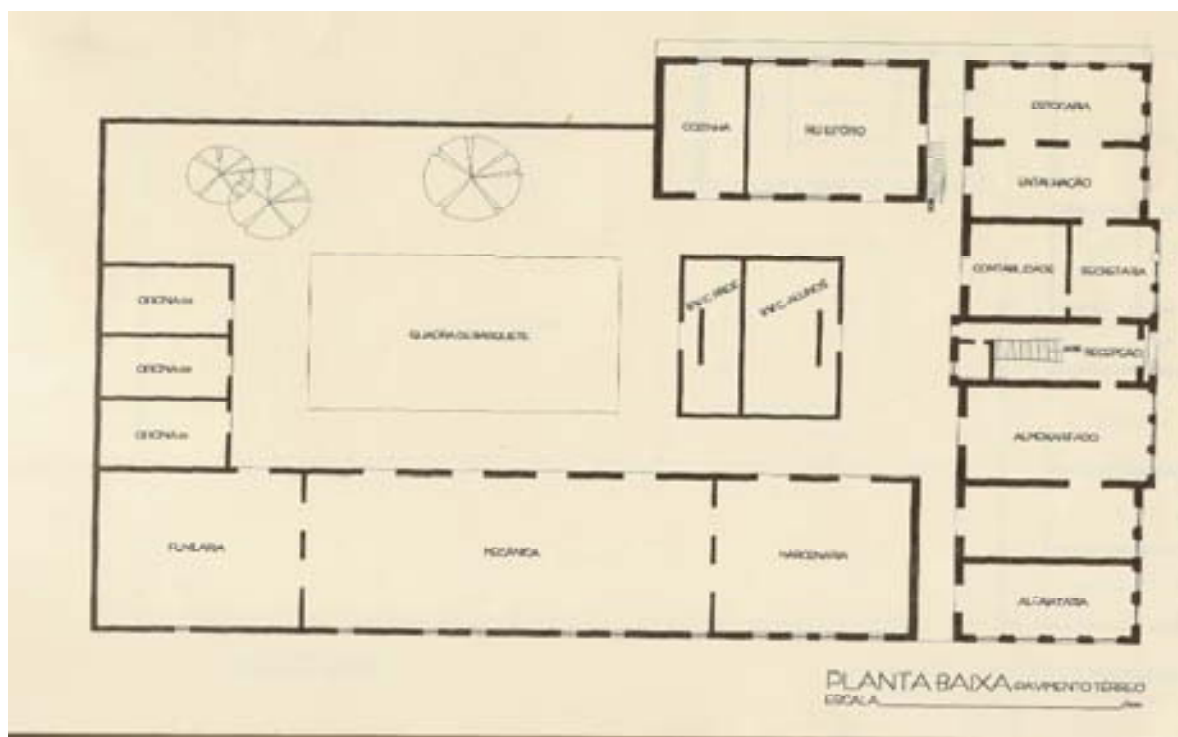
Planta baixa do pavimento térreo do conjunto arquitetônico do edifício da Avenida Rio Branco (por volta de 1940).
